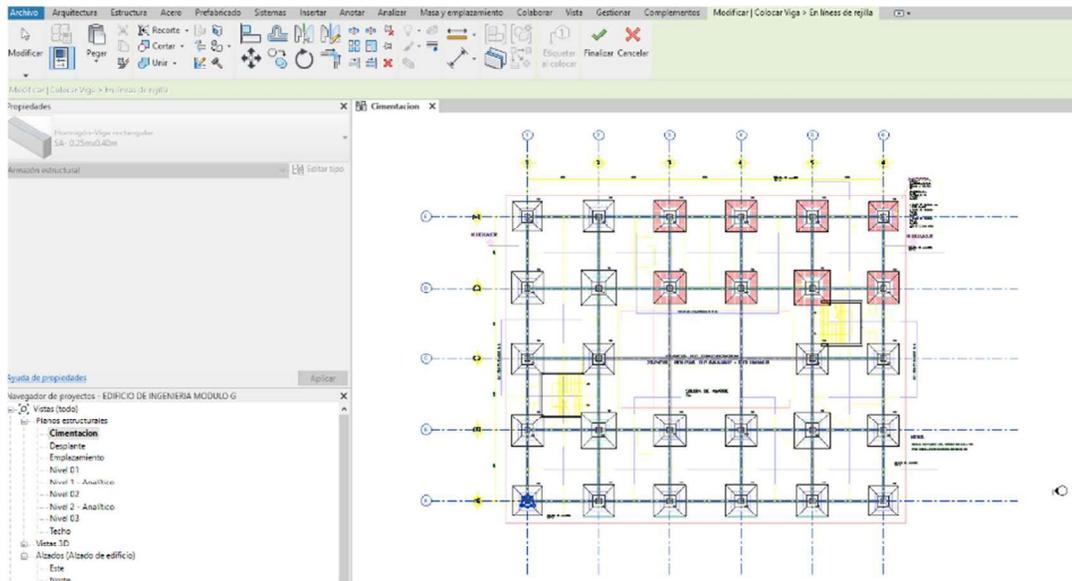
Modificando dimensiones de vigas de amarre en propiedades de tipo
